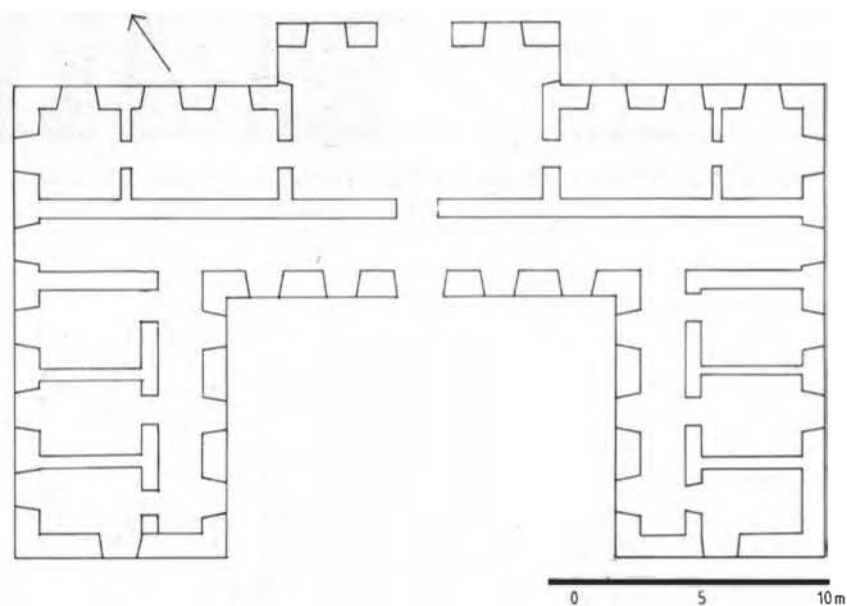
Rekonstruktionsversuch des Grundrisses des ersten Bauzustandes.
